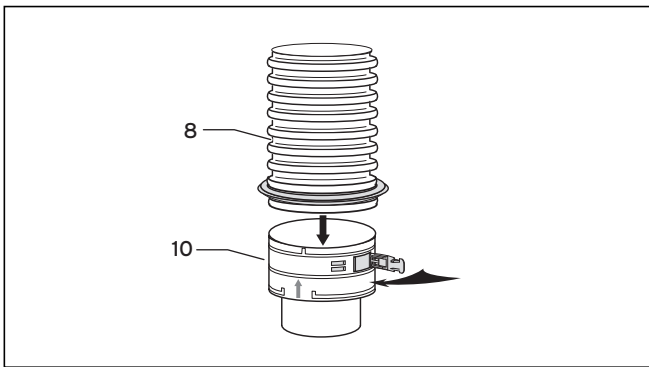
Einsteckelement mit flexibler Abgasleitung
